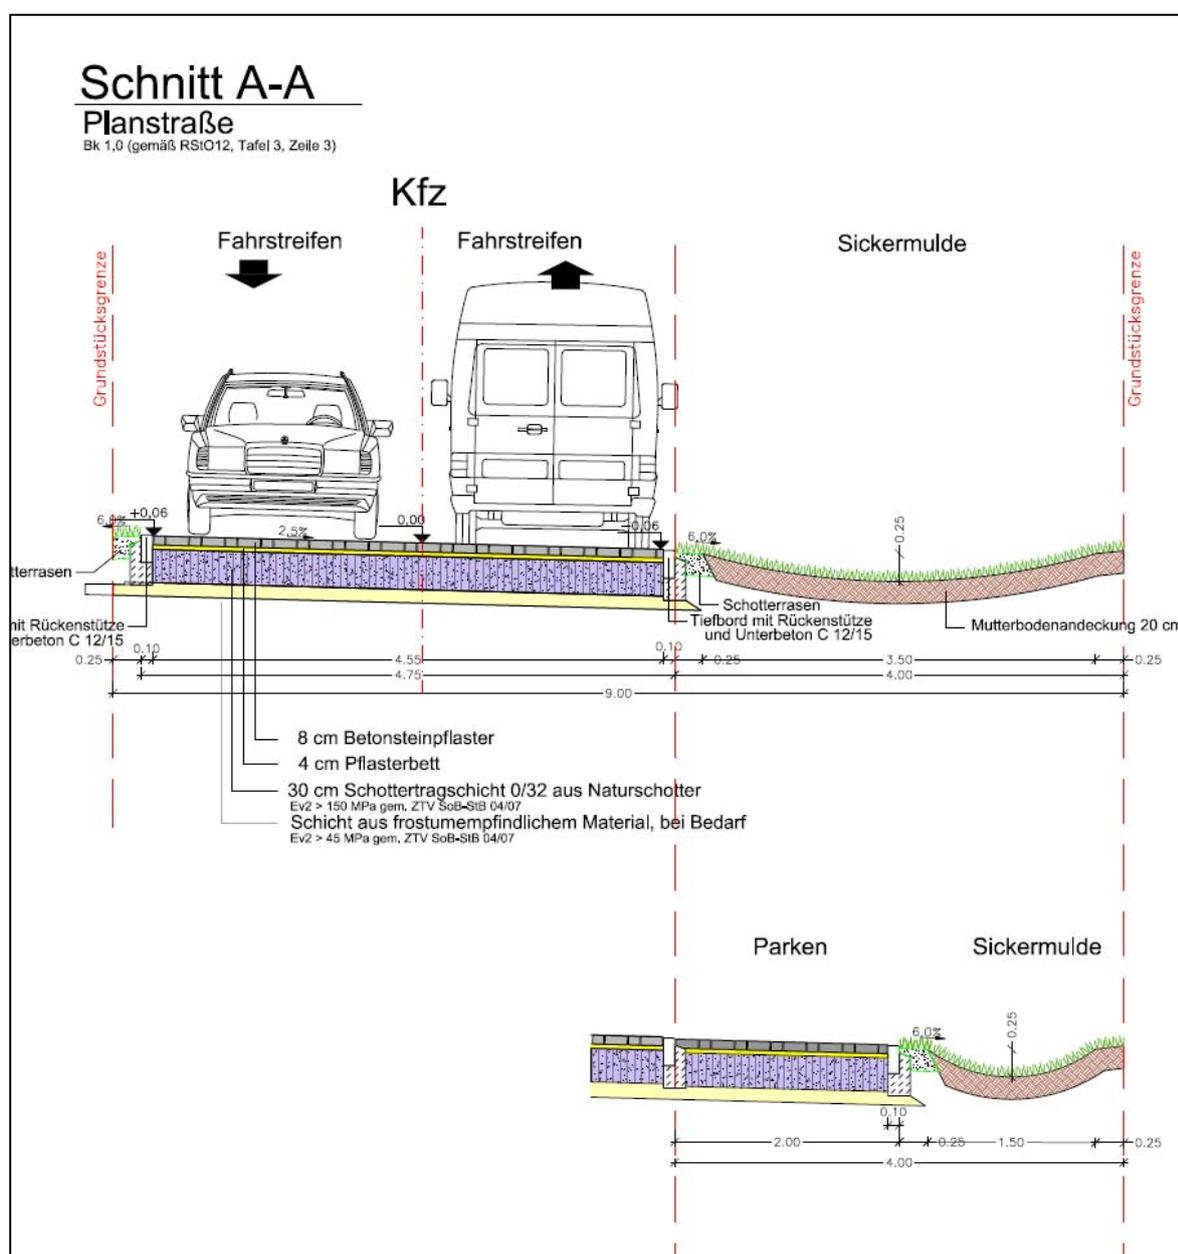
Auszug Regelquerschnitt Erschließungsstraße, Anlage 4.1 Entwässerungskonzept. Erschließung NGB Heidacker 2 in Wittorf, Ingenieurbüro Beußel, 13.08.2021
